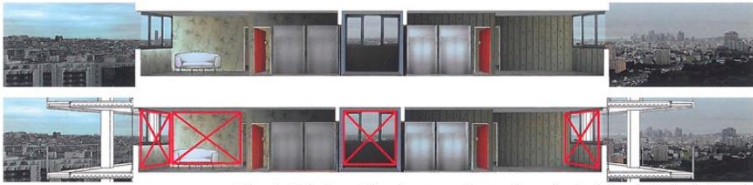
Sección de una planta Estado Original- Rehabilitada
